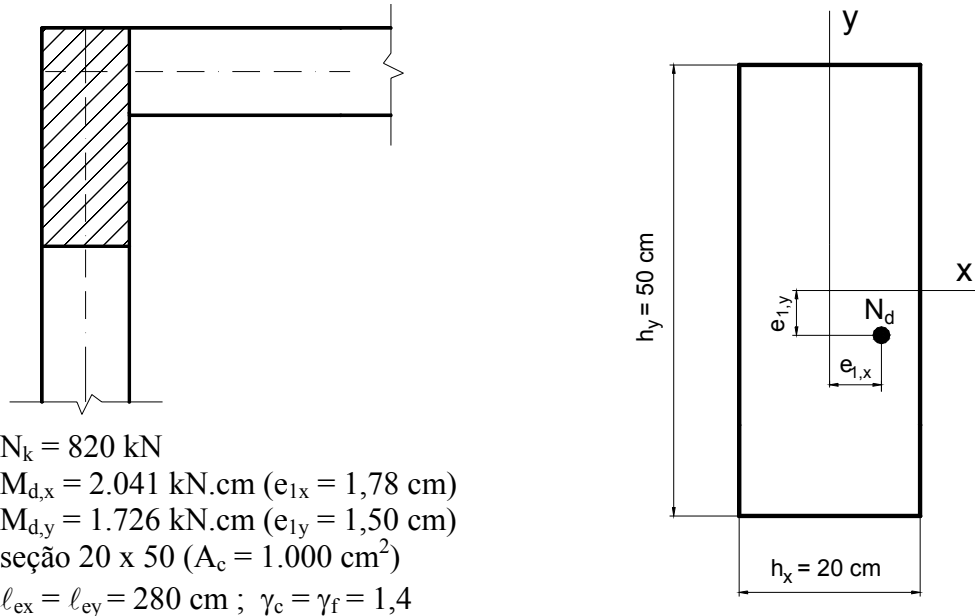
Arranjo estrutural do pilar na planta de fôrma e dimensões da seção.
